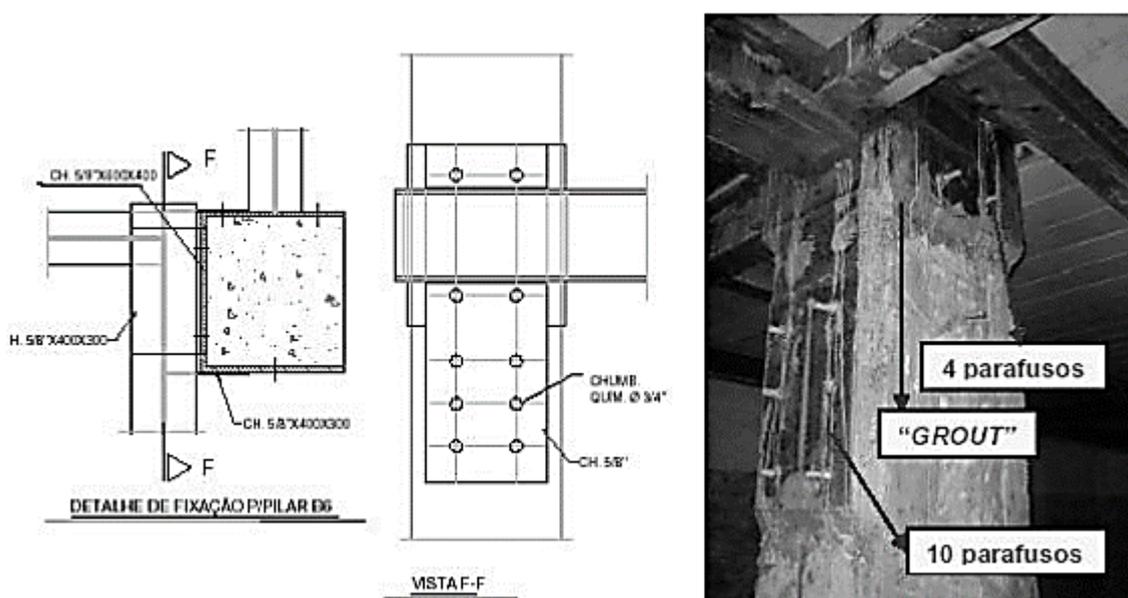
Exemplo de interface com colarinho metálico em pilar de concreto.
